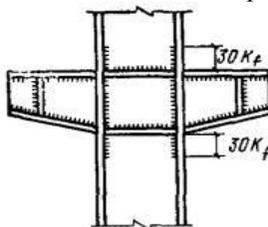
Расположение двухстороннего поясного шва в колонне в узле примыкания балки
